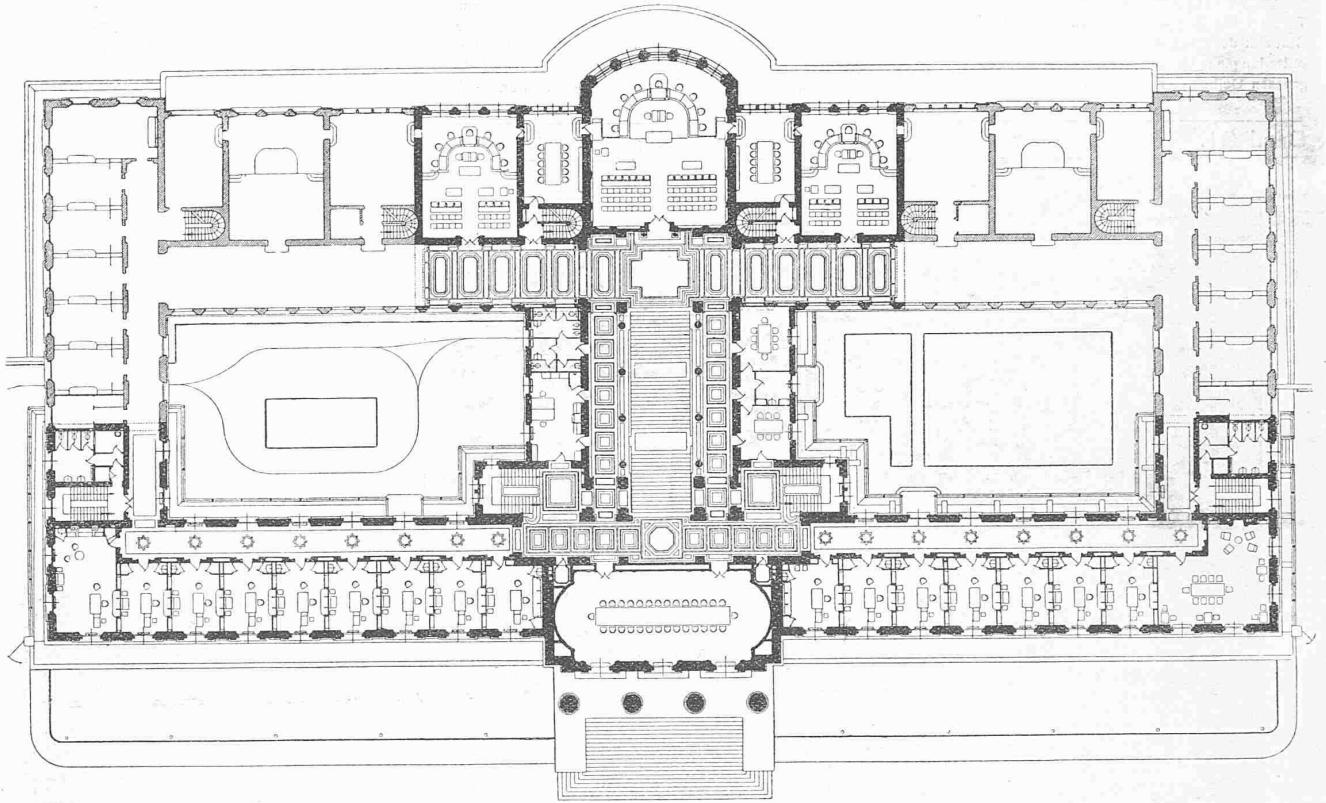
Das neue Bundesgerichtsgebäude in Lausanne. — Grundriss vom Hauptgeschoss, Masstab 1 : 600. (Schraffiert spätere Erweiterung.)
